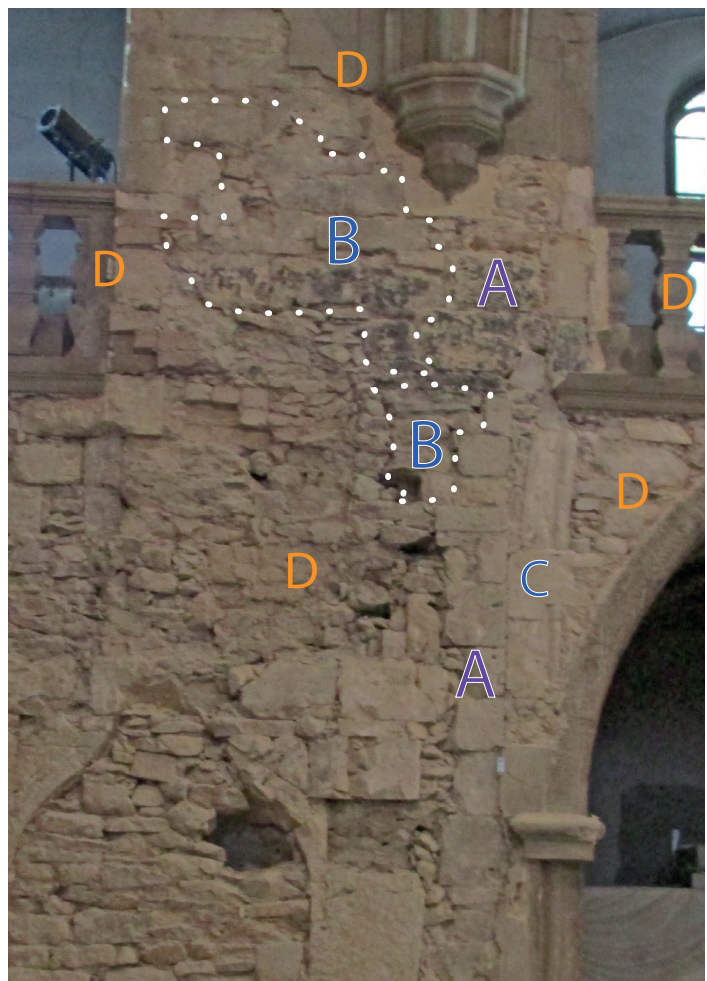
Détail du parement du mur gouttereau septentrional MR1002 entre les chapelles 1 et 2
